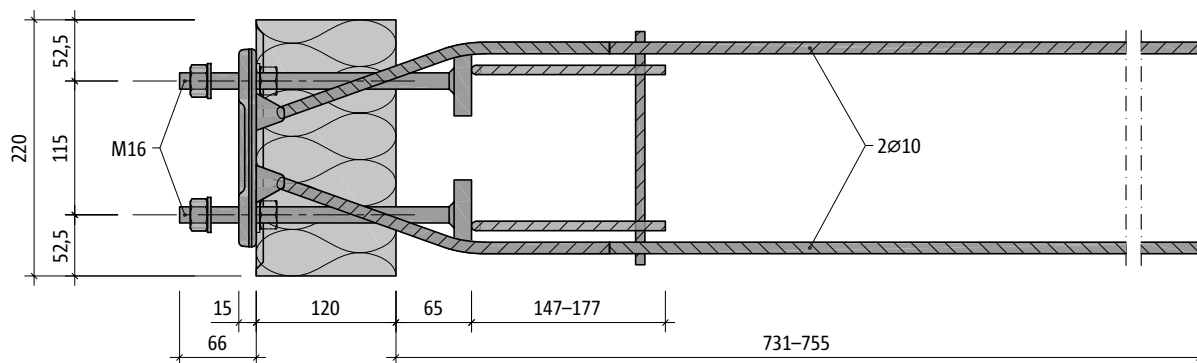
Schöck Isokorb® XT type SQ-V2 : vue en plan
